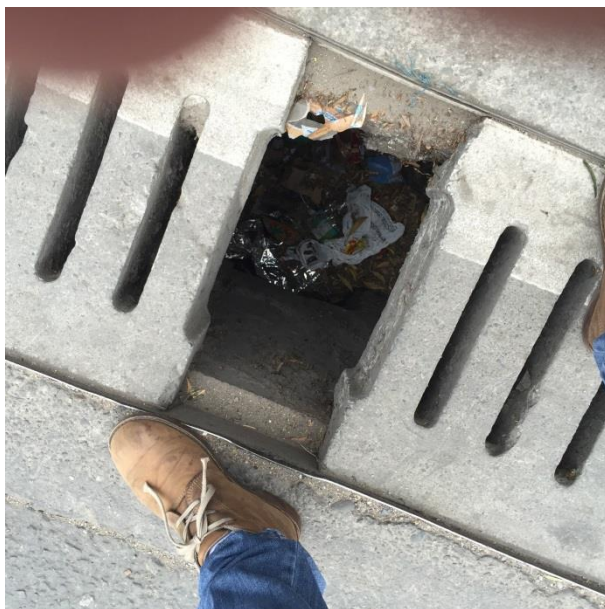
Inspección de tapas de alcantarillado pluvial, referenciando los códigos de los pozos que están referenciados en la plancha de alcantarillado pluvial H4.
